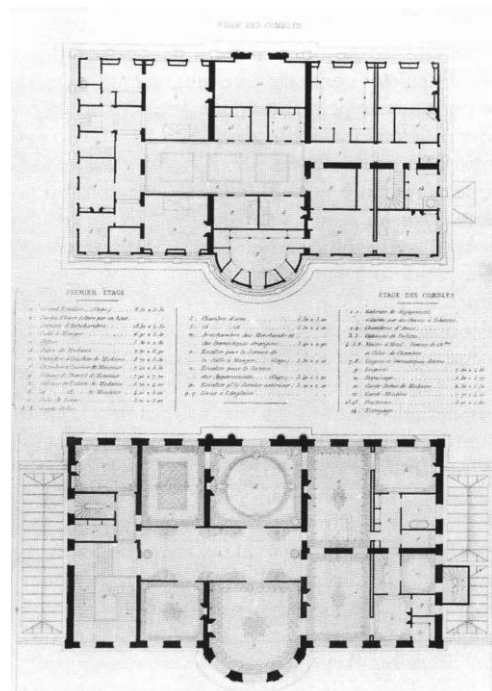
Planta baixa do primeiro pavimento e do sótão do *hôtel privé* projetado pelos arquitetos Nolau e Convents, 1867, Paris. Fonte: HOMEM, 1996: 26.
